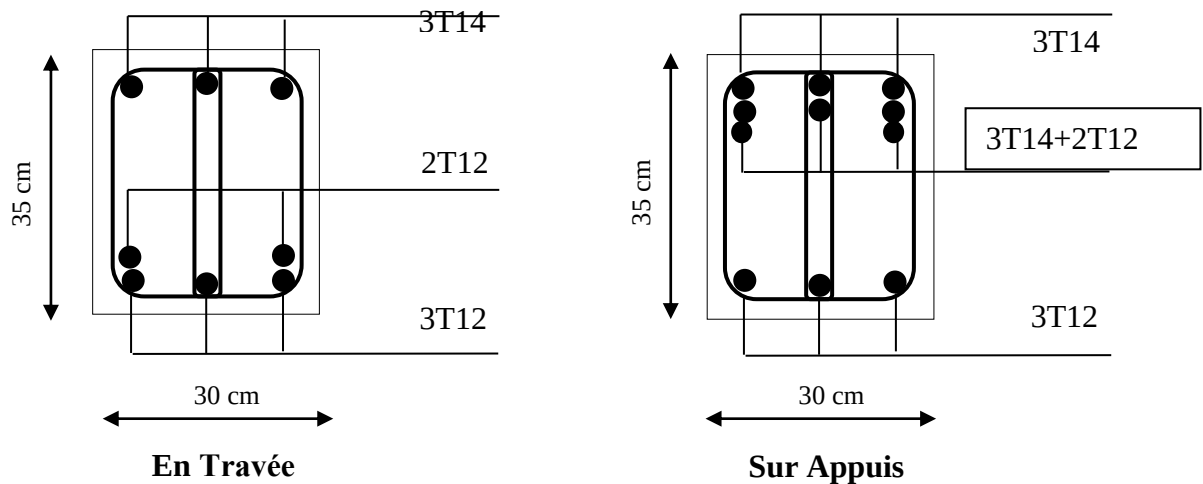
Schéma de ferrailage d'une poutre secondaire
